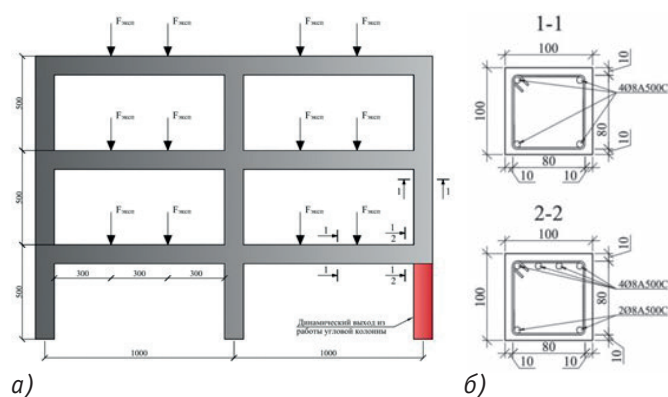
Исходные данные для моделирования: а) расчётная схема железобетонной рамы, б) армирование элементов рамы
